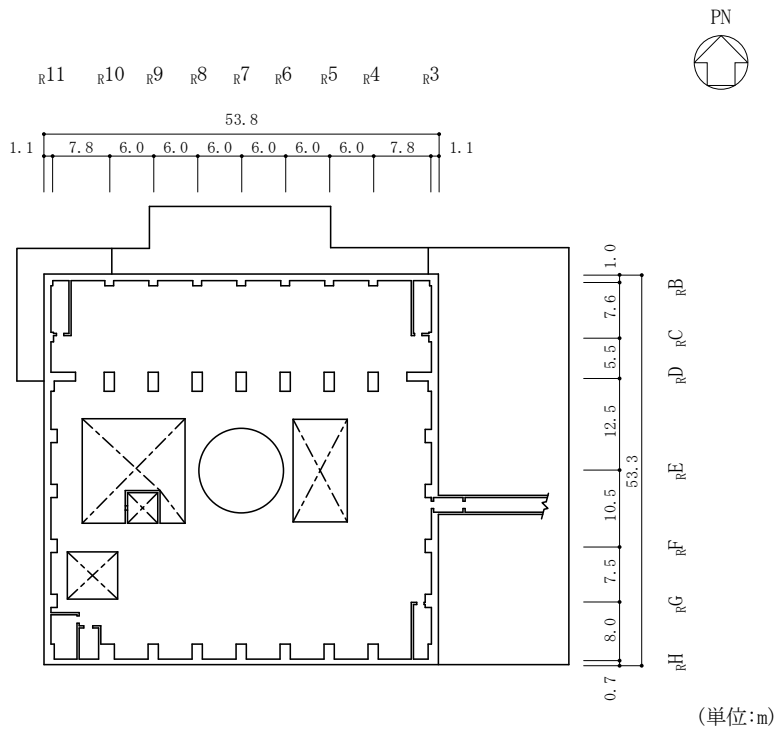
(7) 原子炉建物の概略平面図 (EL 42.8m)
